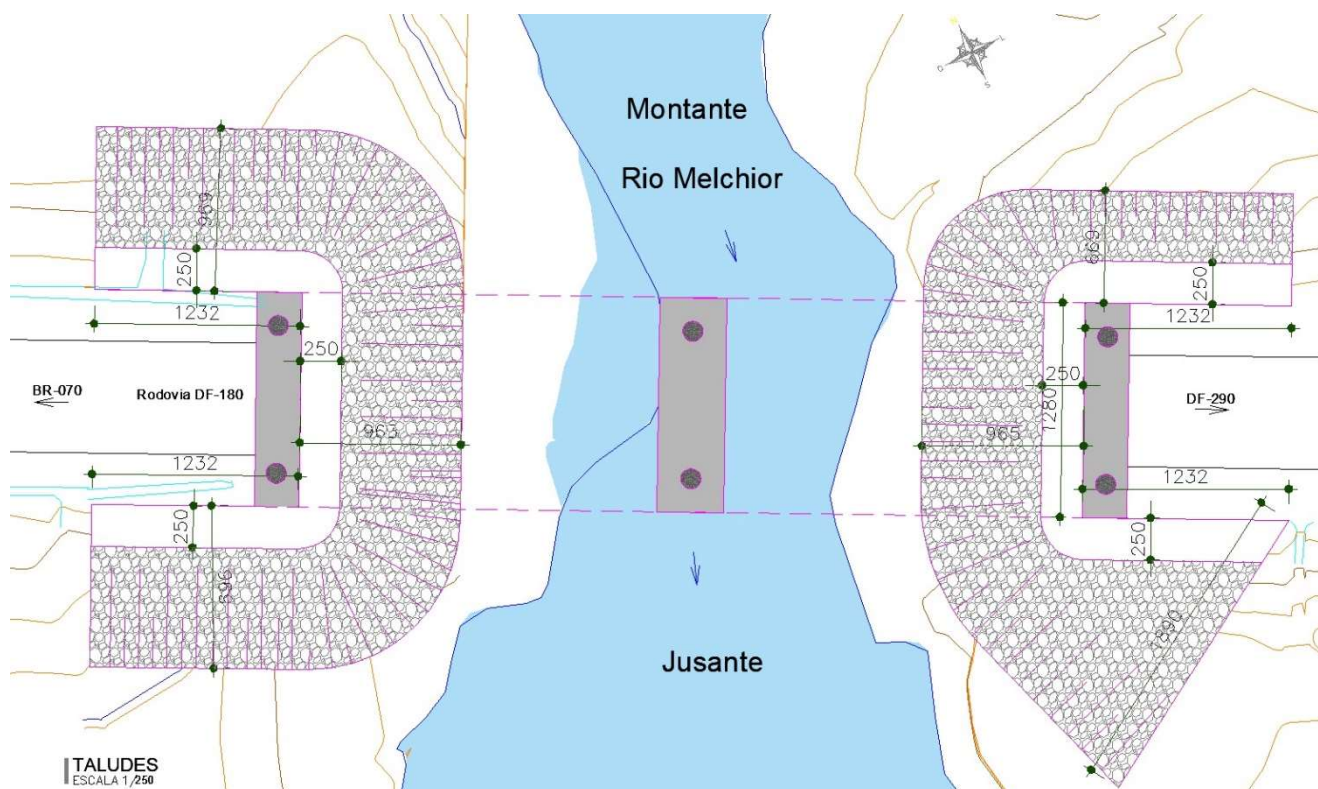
planta da proteção do talude em gabião tipo colchão Reno.
